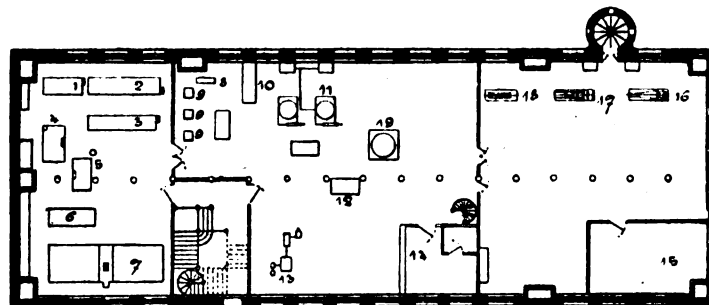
Grundriss vom ersten Obergeschoss.
